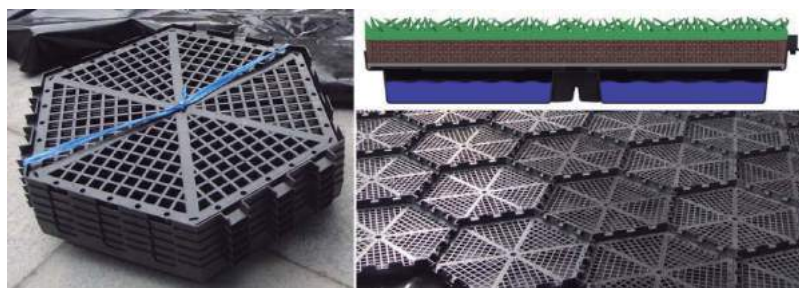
Telhado verde – Sistema Hexa (Ecotelhado). Fonte: Site do fabricante (2015).
